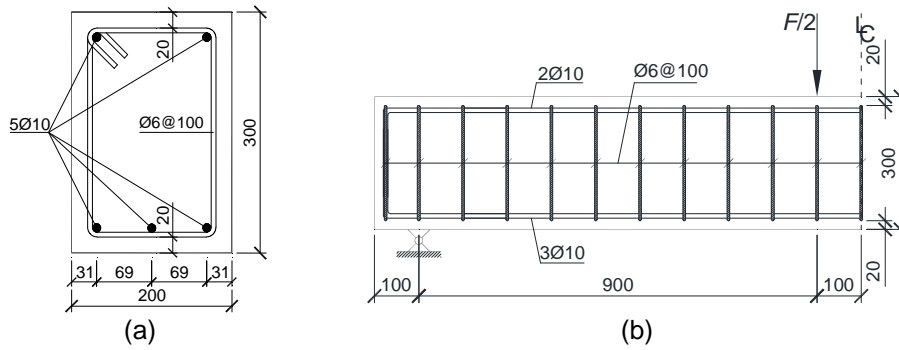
Vigas de BA: (a) secção transversal; (b) vista longitudinal. Nota: todas as dimensões estão em milímetros.
